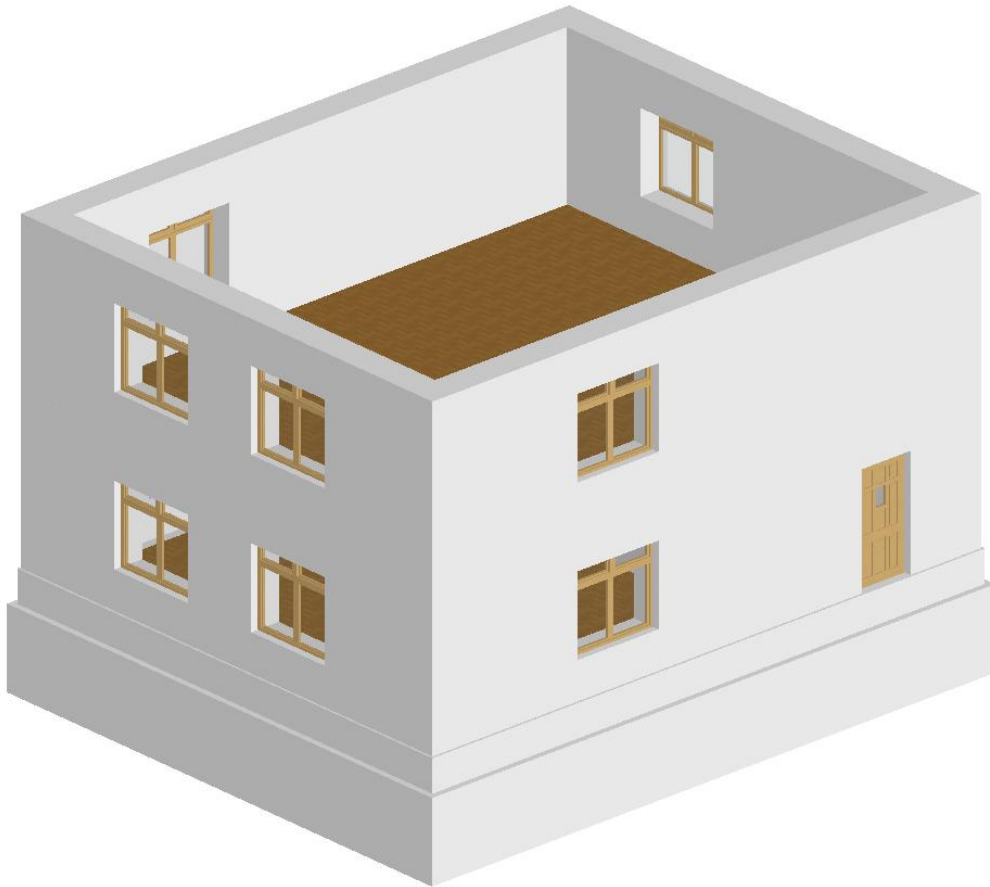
Общий вид двухэтажного дома с цокольным этажом и фундаментом
